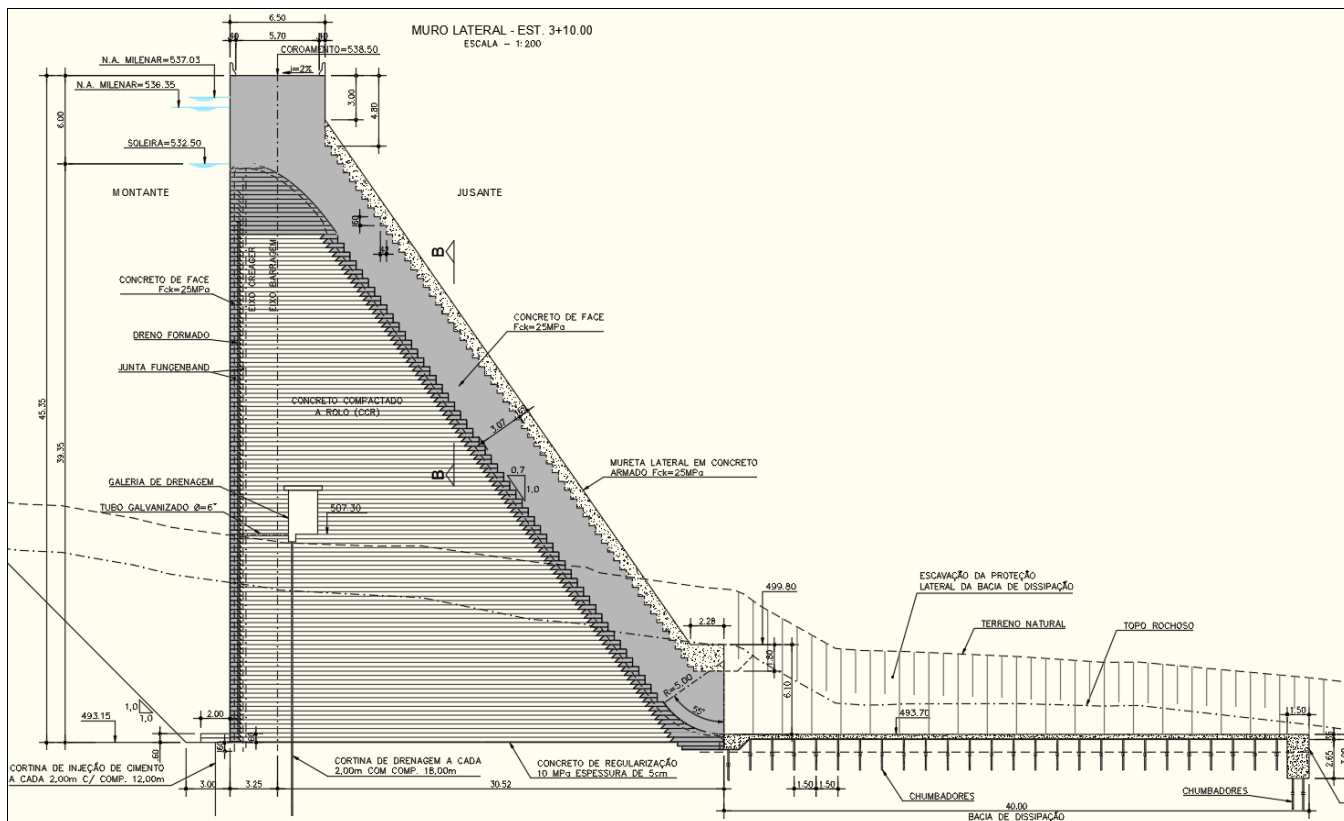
Seção tipo da barragem (submersível), vertedouro e bacia de dissipação
